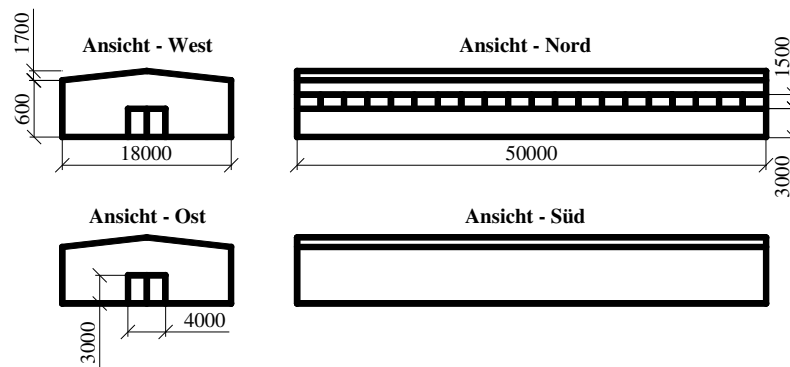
Entwurfsobjekt 1 - einschiffige Halle
